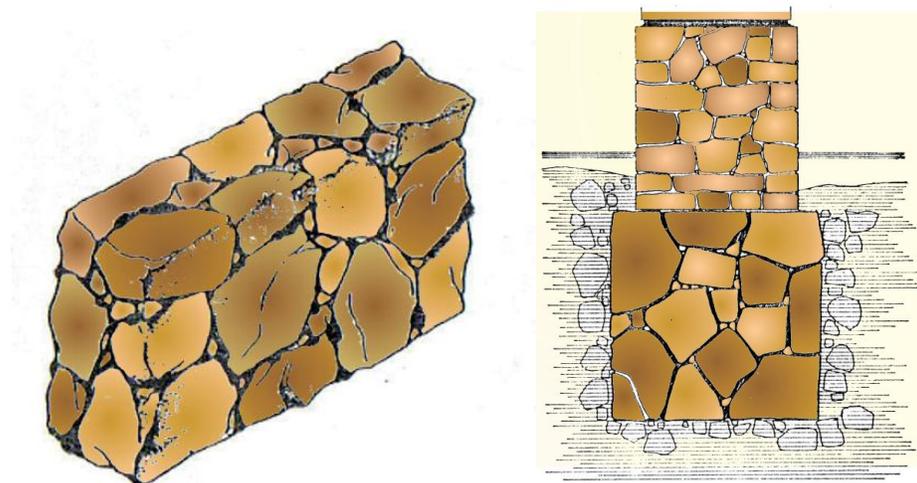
Detalles de la colocación de piedra en la construcción de un cimiento de mampostería.
